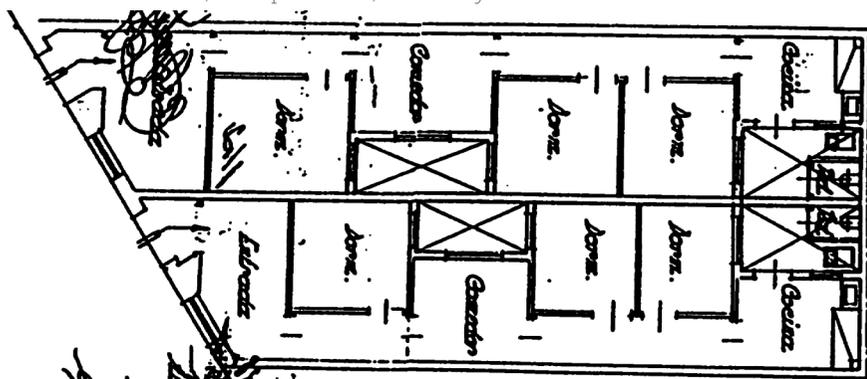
| Guillermo Langle. Carrera de Castro. 1941.
